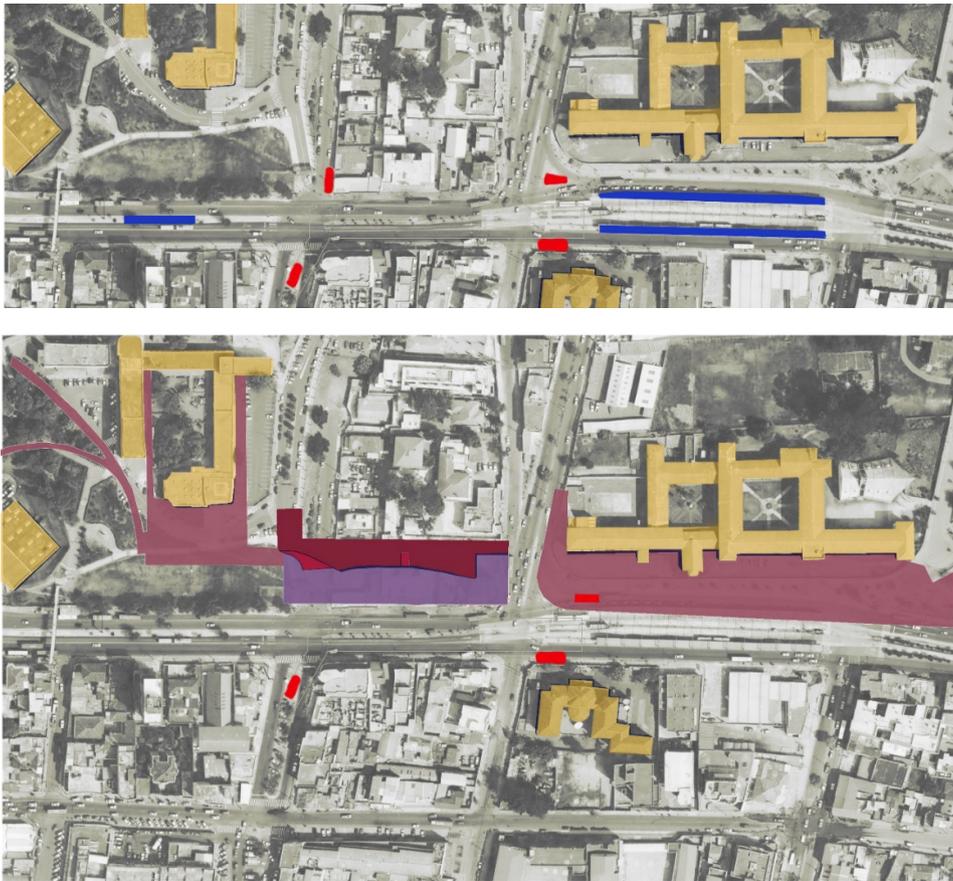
Planta de la actuación propuesta de la planta existente con las paradas de autobús y las propuestas de salida de metro diseñadas por Metroquito y la planta propuesta por nuestro equipo con las tres plazas y los edificios más significativos.
